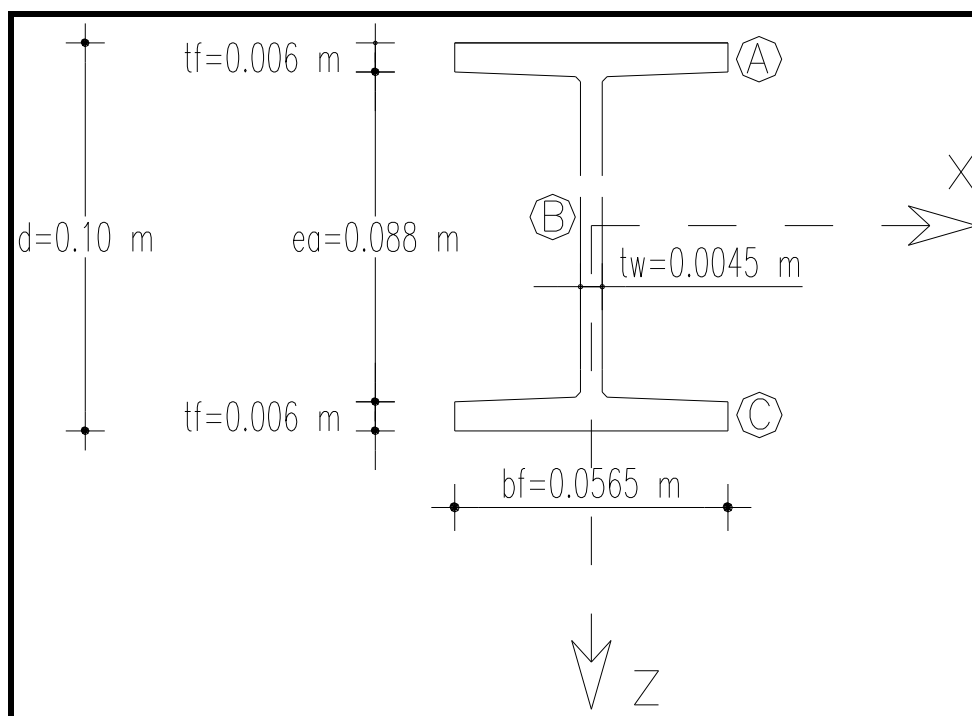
GEOMETRIA DE LA VIGA METÁLICA
